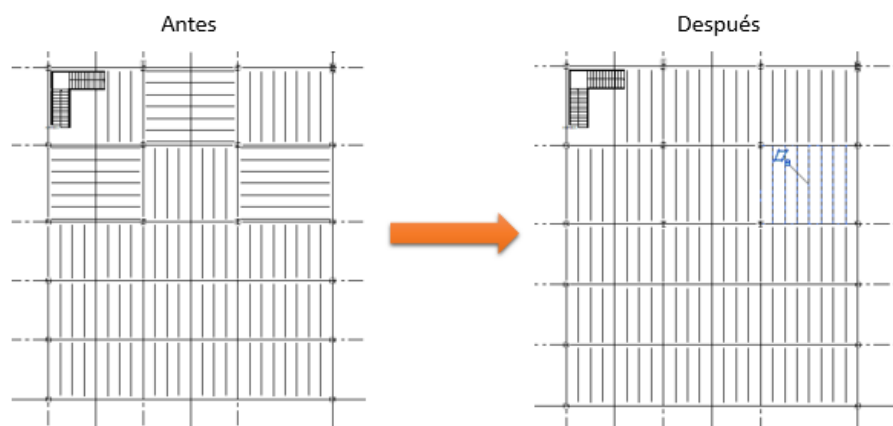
Resultado tras la modificación de la dirección de las vigas.
